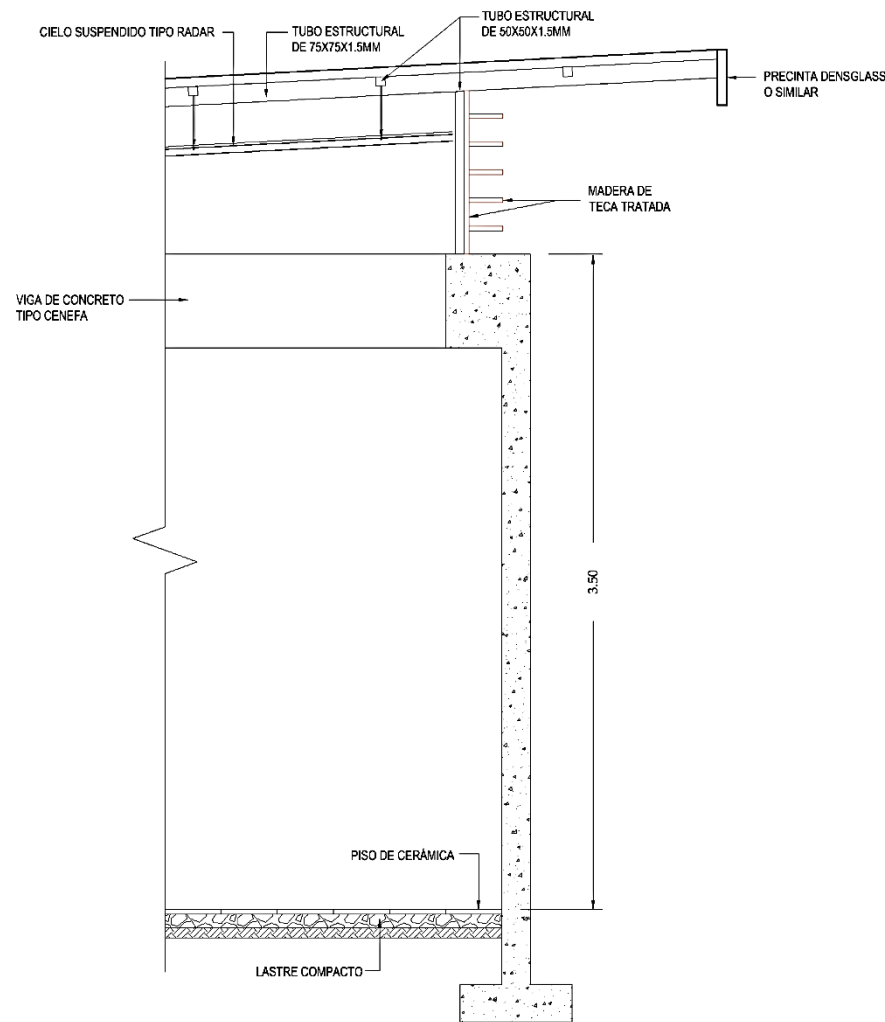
Detalles estructurales. Fuente: elaboración propia.
